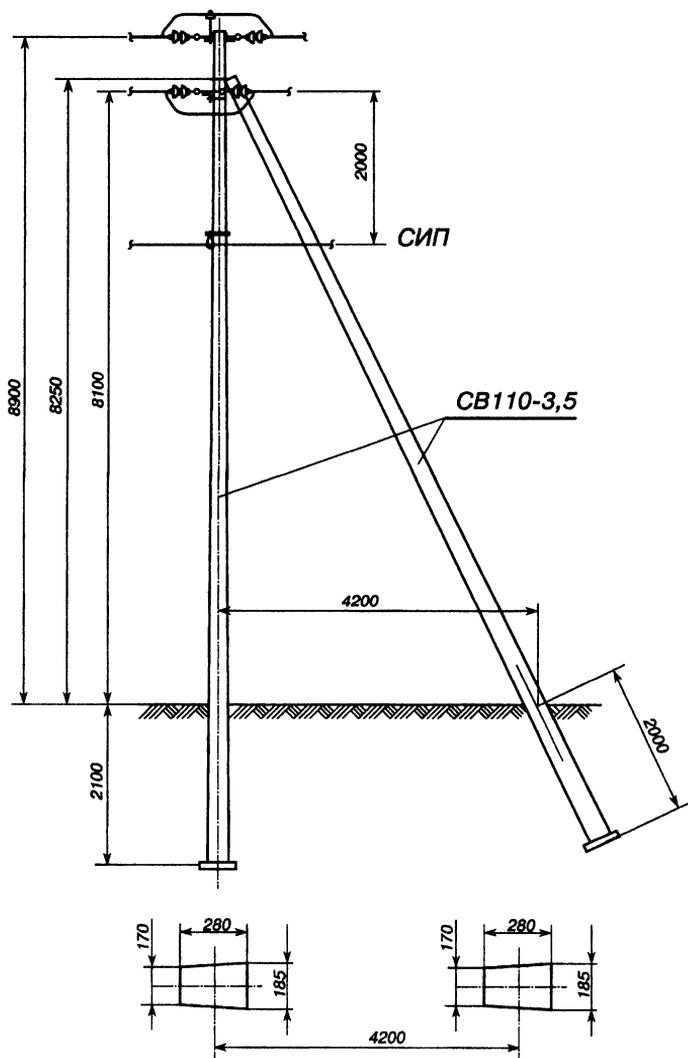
Угловая железобетонная опора для совместной подвески проводов ВЛ 10 кВ и ВЛ 0,4 кВ с проводами СИП (АМКА)
